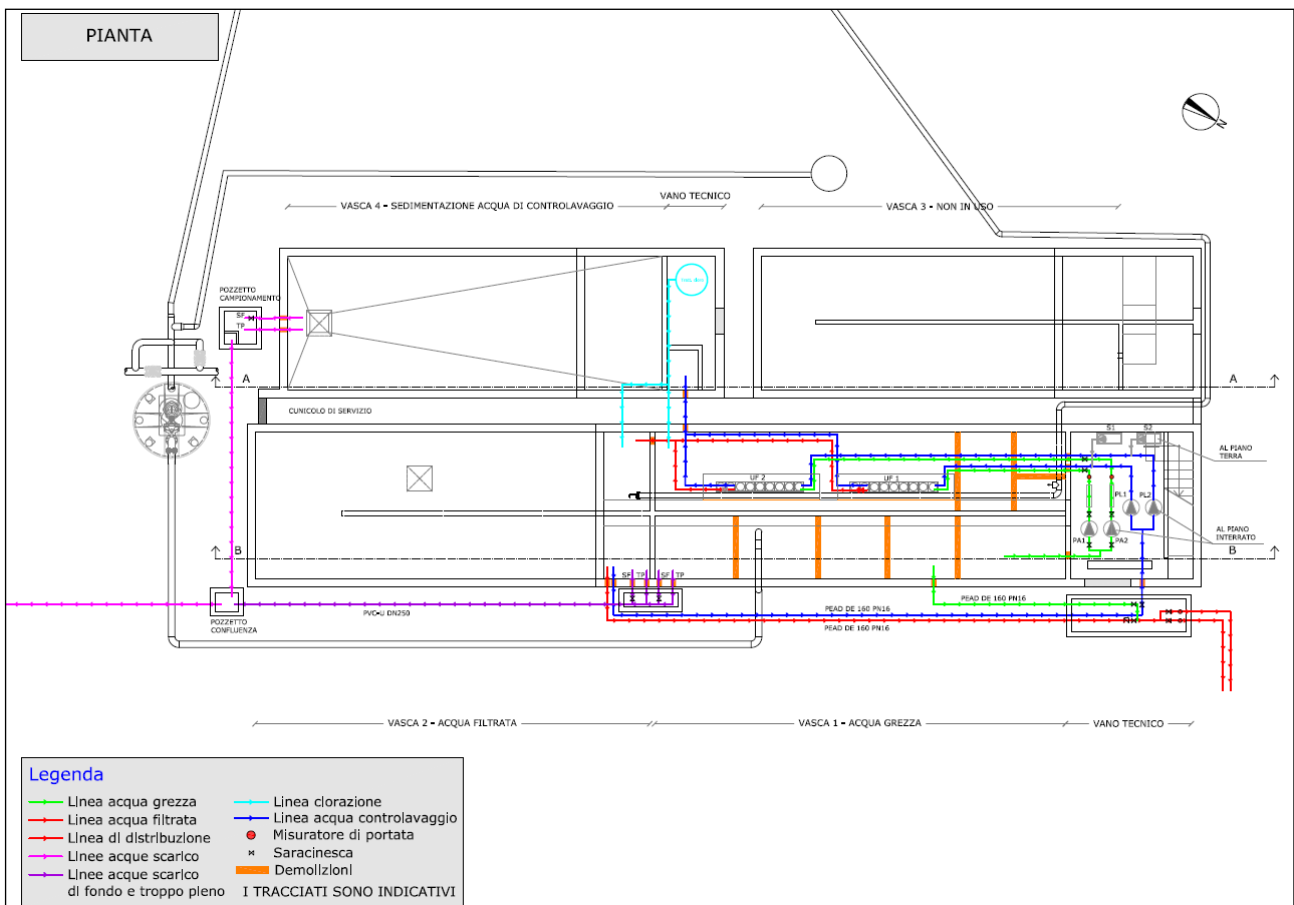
Pianta non in scala dell'intervento previsto secondo il Progetto Definitivo/Esecutivo.
